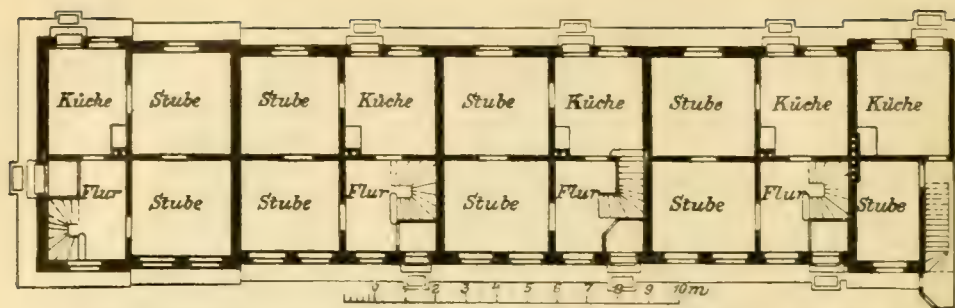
Einfamilienhausgruppe der Harburger Gummi-Kamm-Kompagnie. Grundriss der Erdgeschosse.
